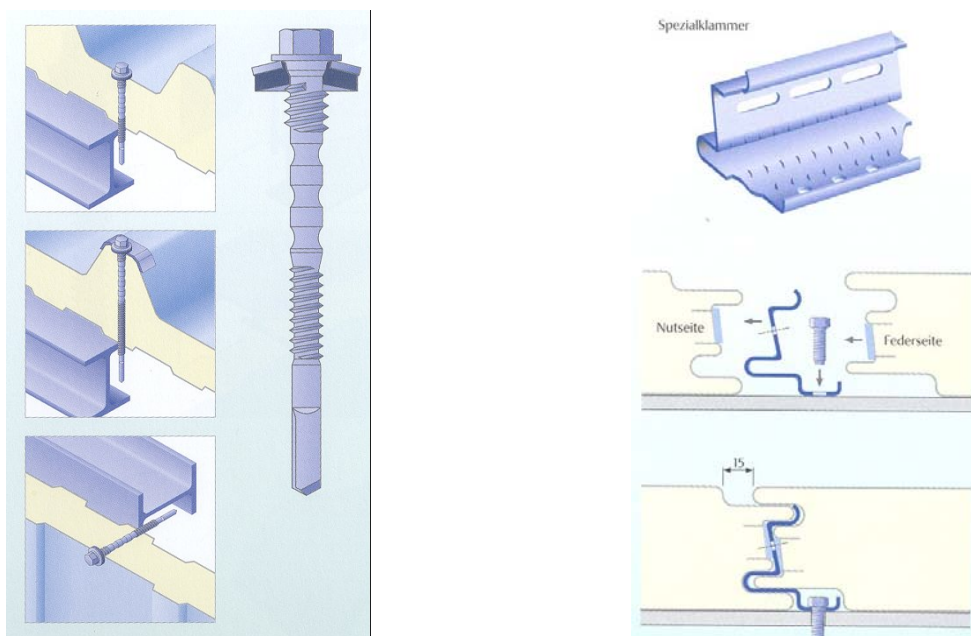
Selbstbohrende Stahlschraube für Durch-und-Durchverschraubungen von Sandwichelementen mit Stahl- und Holzbauteilen (links), Befestigungsklammer zum Fügen von Sandwichelementen mit einer tragenden Struktur (rechts) [3]
